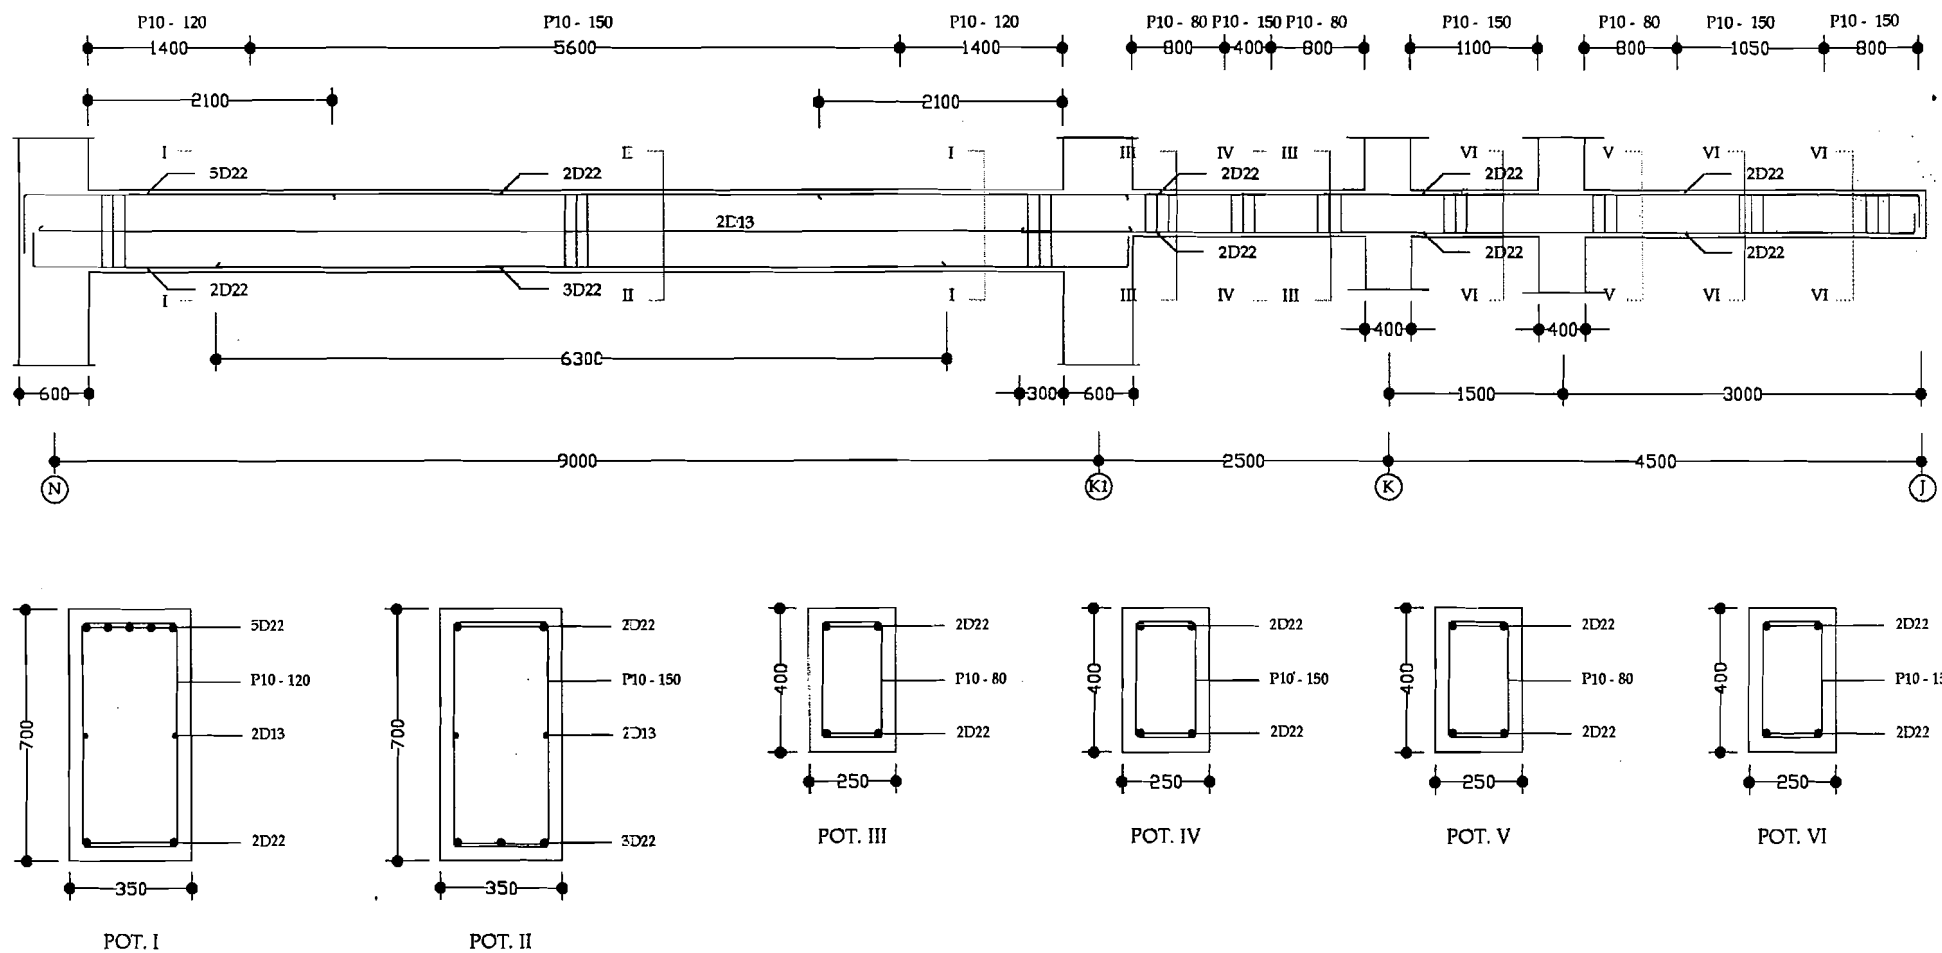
Denah Rencana Balok Induk Lantai 4
